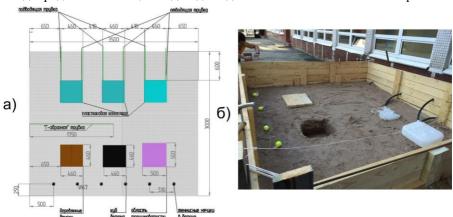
Модель сегмента бетонной крепи: а) схематическое представление, вид сверху; б) внешний вид модели до заливки бетона
